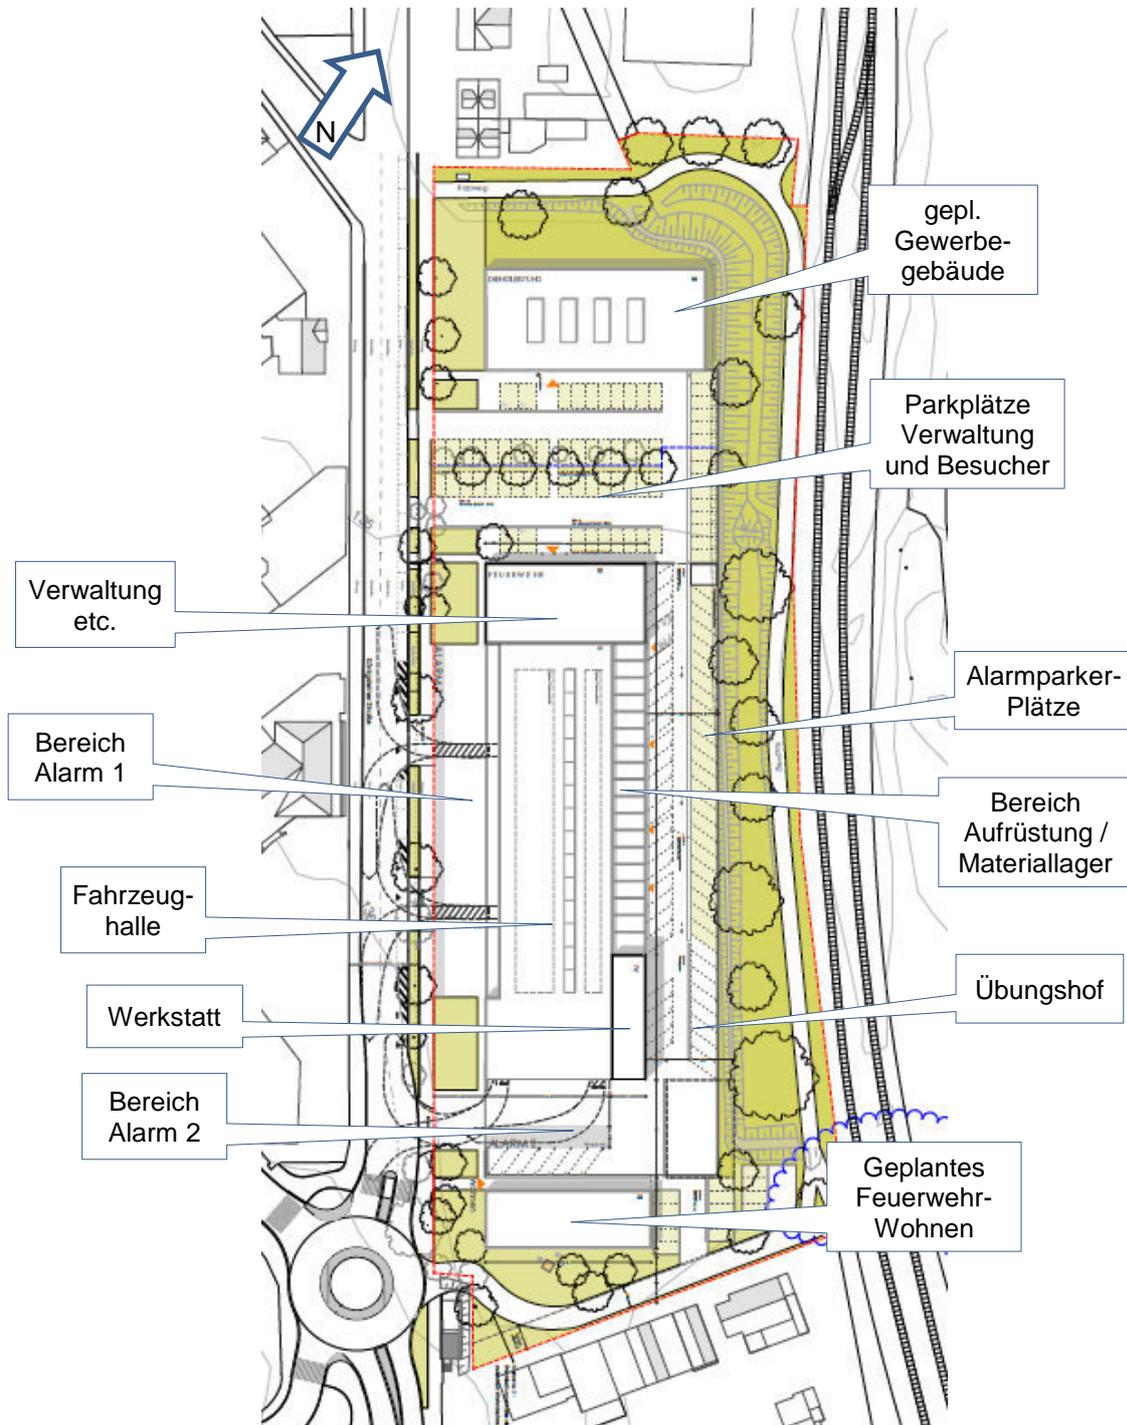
Grundrissplan Feuerwehrstandort
